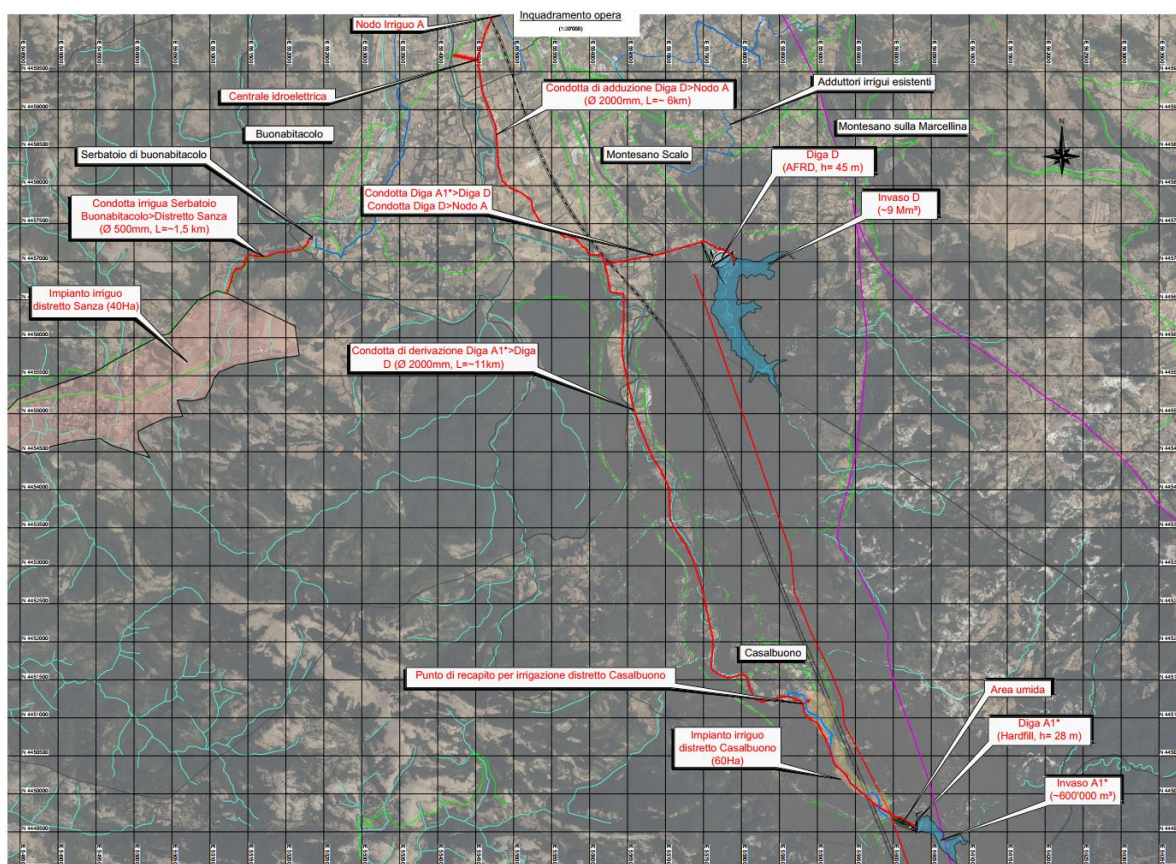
Alternativa 2 (A1*+D), schema progettuale planimetria (estratto da [19])
